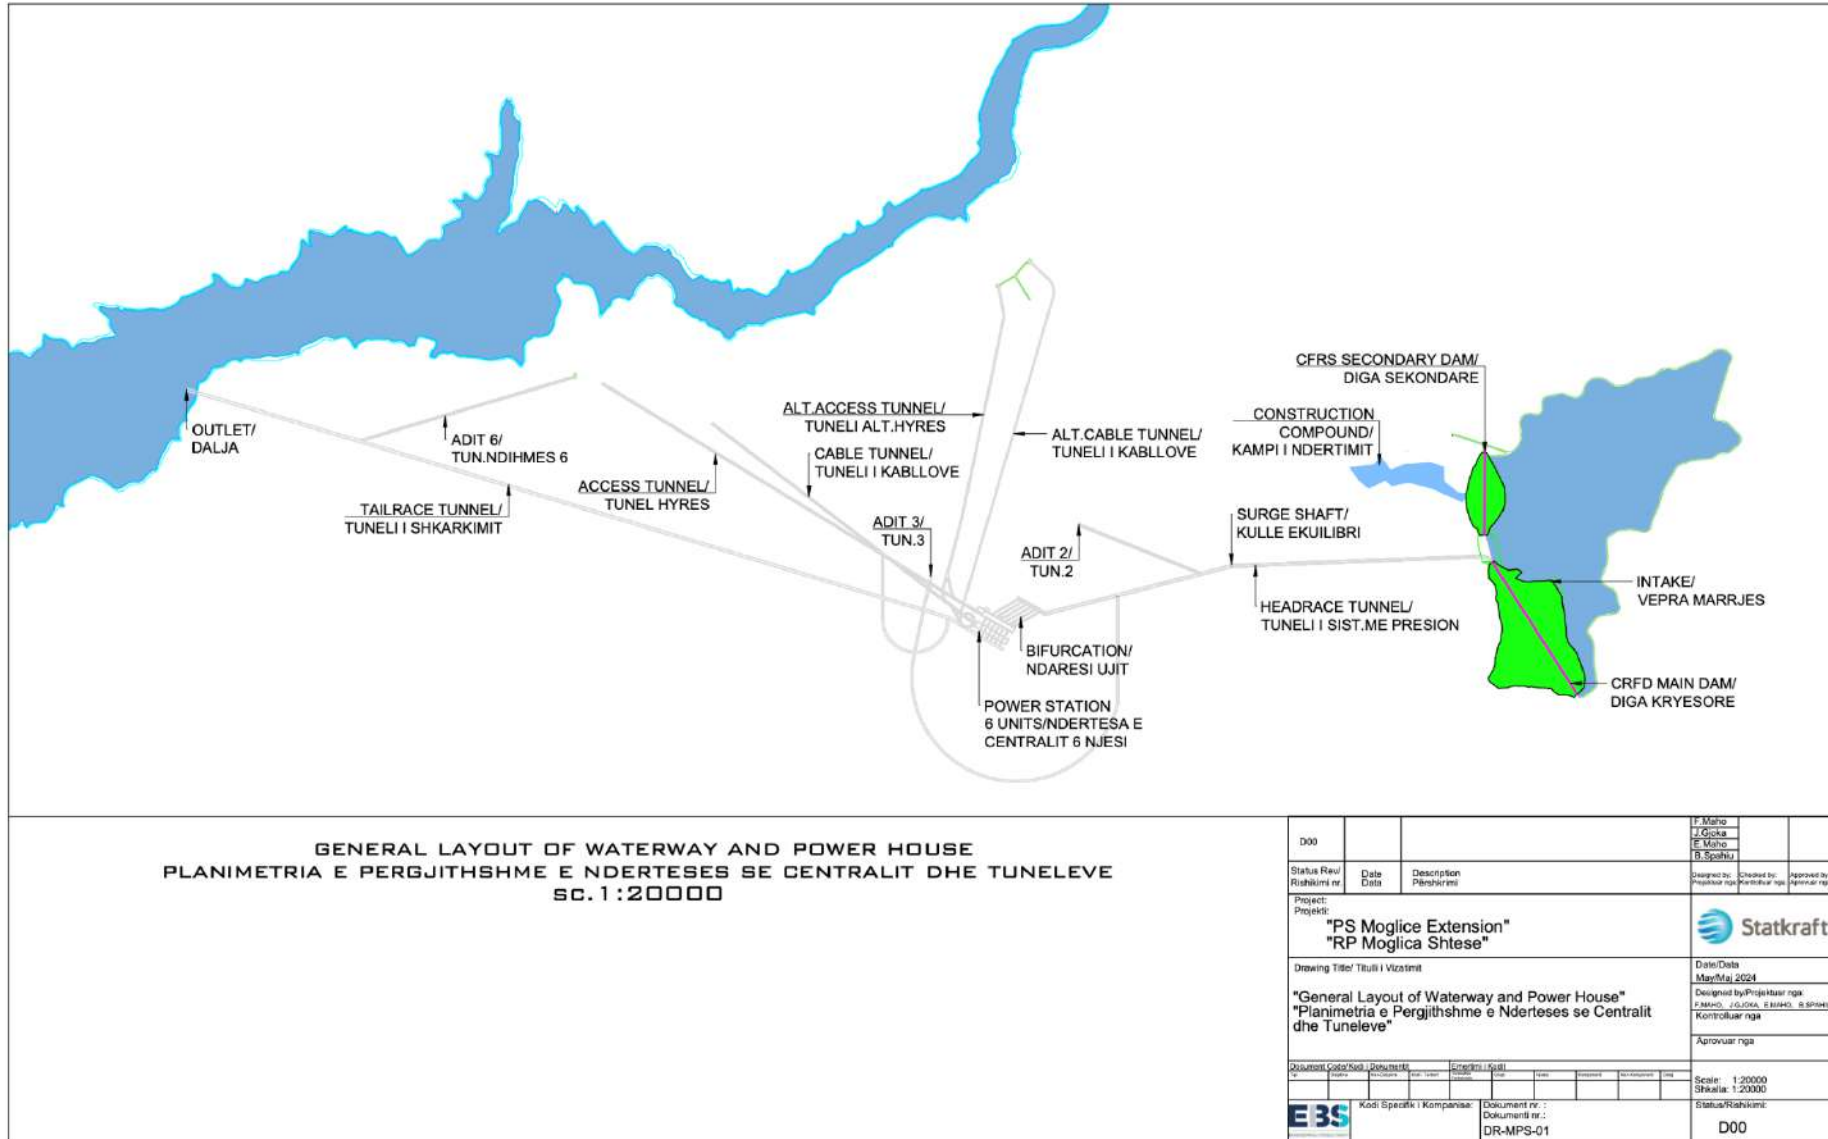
Planimetria e përgjithshme e strukturave të projektit
